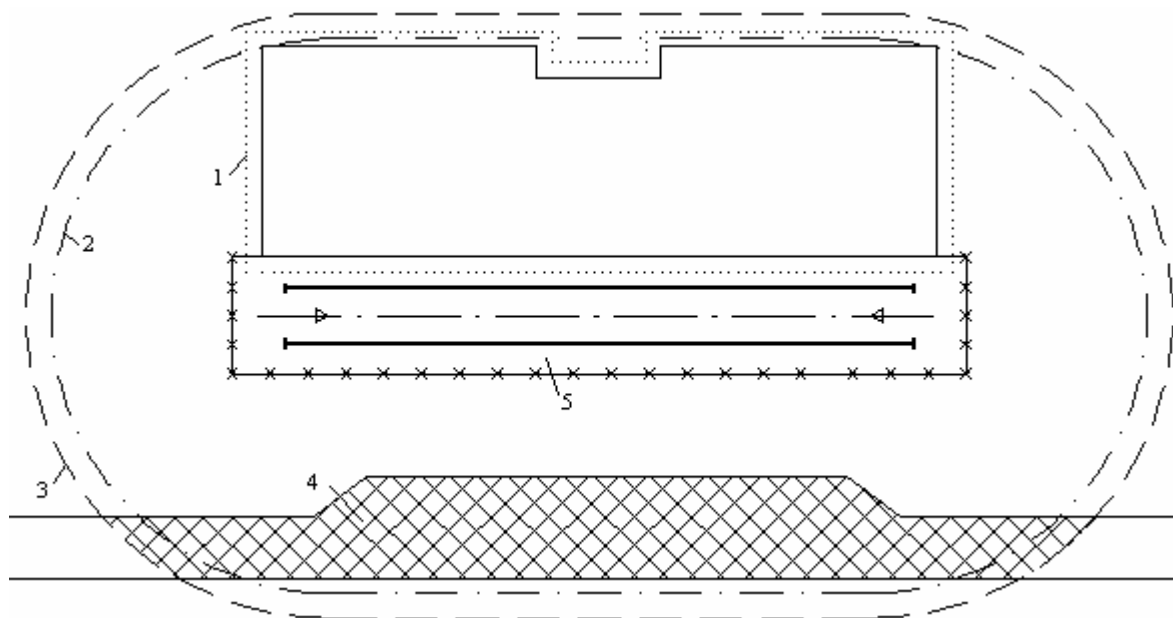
Опасные зоны при работе крана: 1 – монтажная зона; 2 – зона работы крана; 3 – опасная зона; 4 – опасная зона дороги; 5 – опасная зона подкрановых путей
